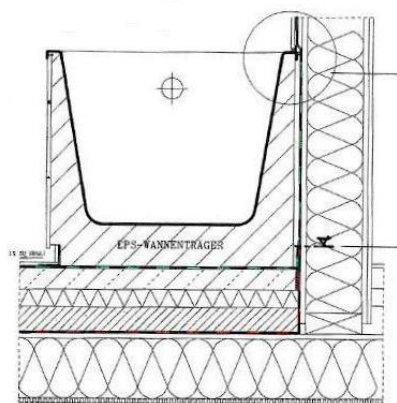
Badewannenaufstellung mit Sekundärabdichtung<sup>65</sup>
